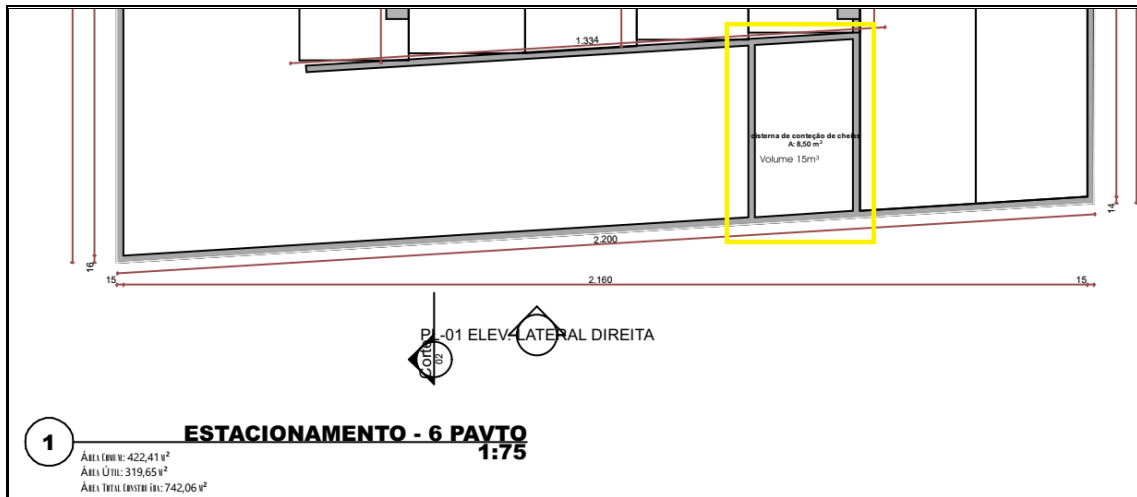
Área de armazenamento para reaproveitamento de águas pluviais (em destaque).
